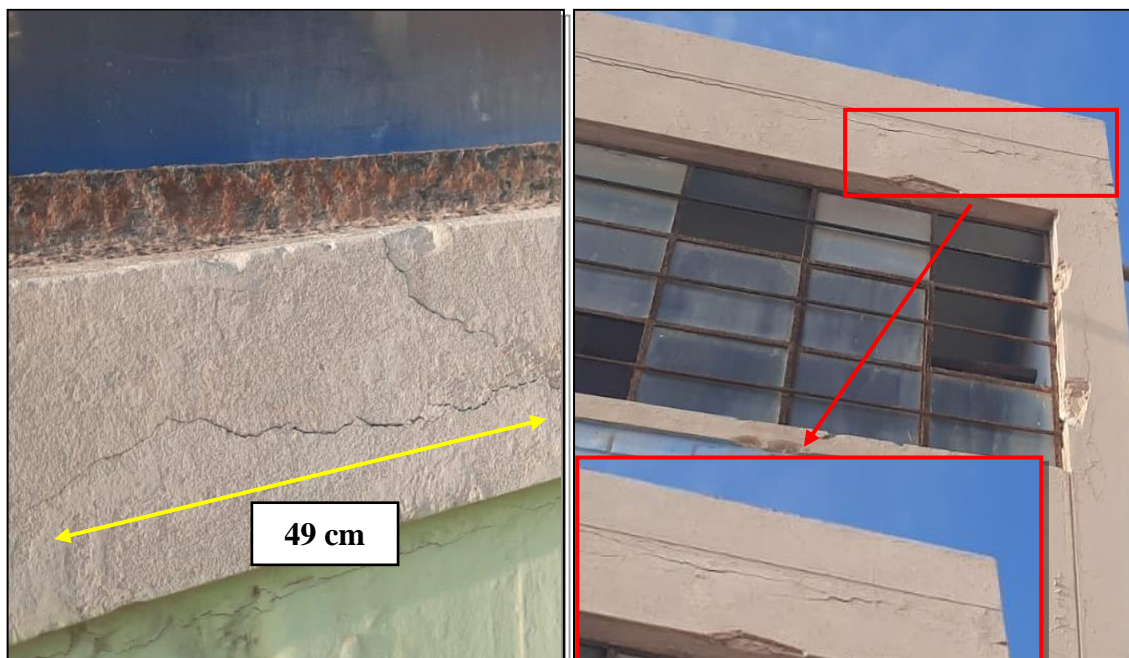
Fisuramiento de la viga solera y viga estructural del bloque A
